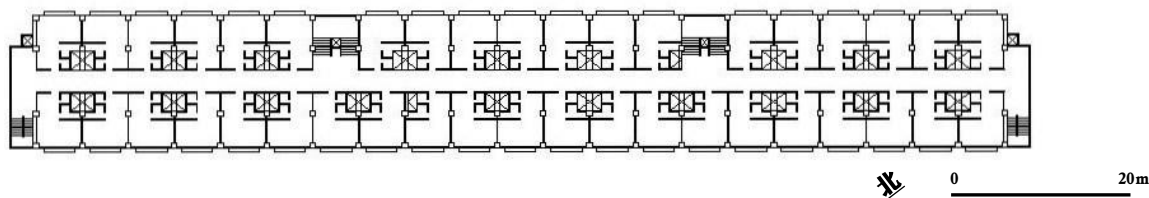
劍潭二期整宅標準層平面圖（二至五樓住宅單元）
